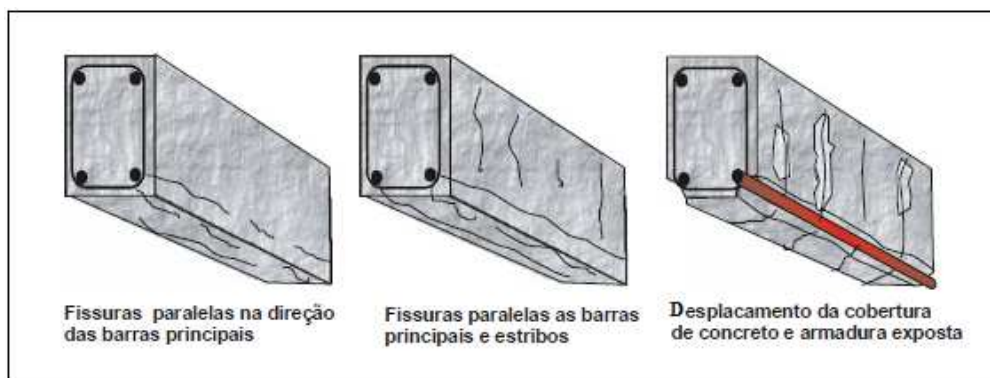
Fissuração e lascamento do concreto paralelamente às barras e estribos metálicos. Fonte: Husni (2003) *apud* Polito (2006).
